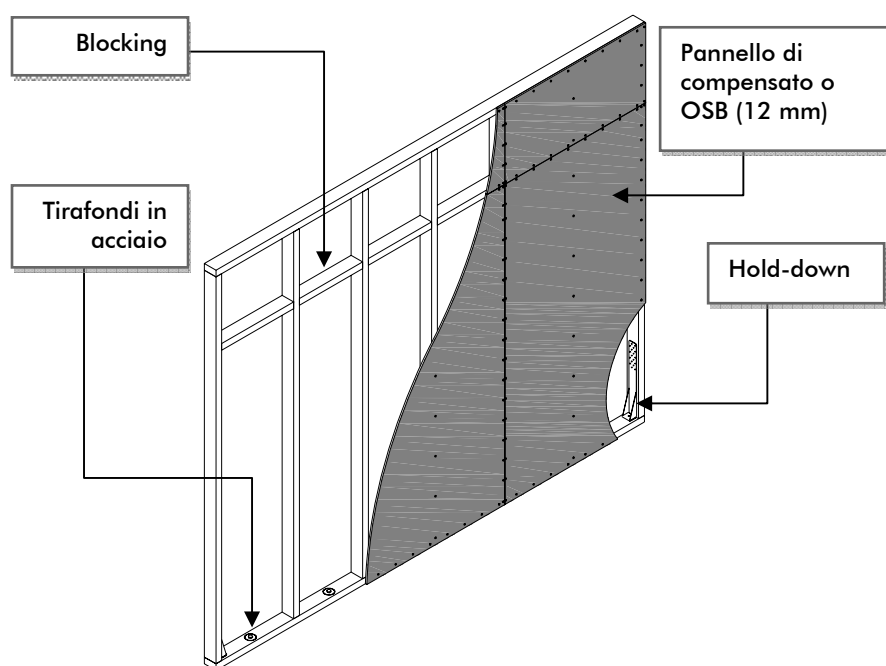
Dettaglio strutturale di una parete Platform con collegamento del pannello strutturale di compensato/OSB tramite chiodi e elementi di collegamento alla fondazione.
